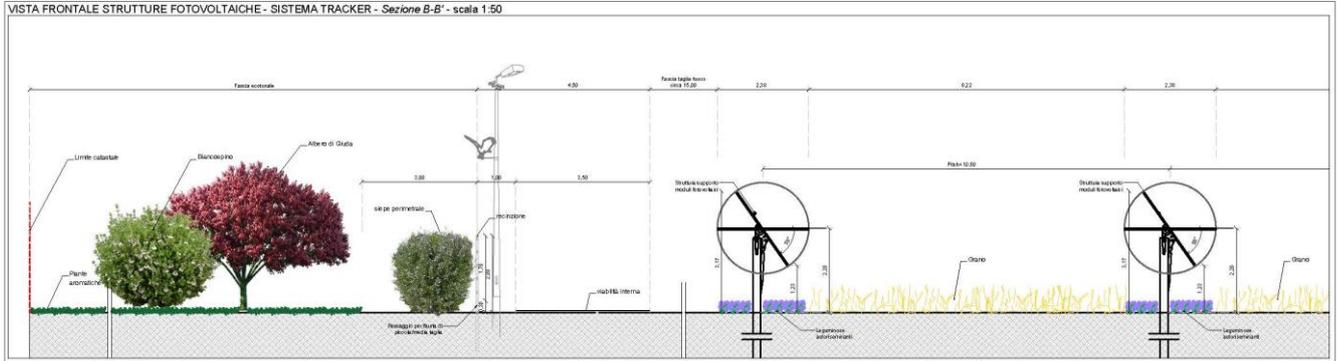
Sezione tipo coltivazione cereali tra le fila delle strutture fotovoltaiche
